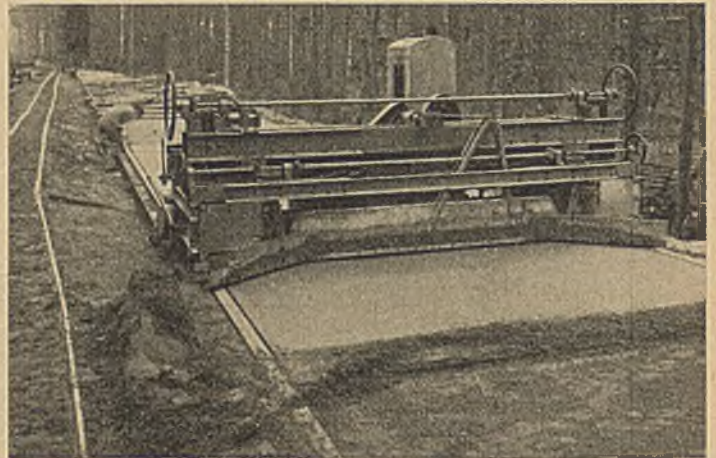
Hammerfertiger mit Vorrichtung zum Einbringen eines Farbstreifens in die Betondecke der Dinglerschen Maschinenfabrik A.-G., Zweibrücken.
